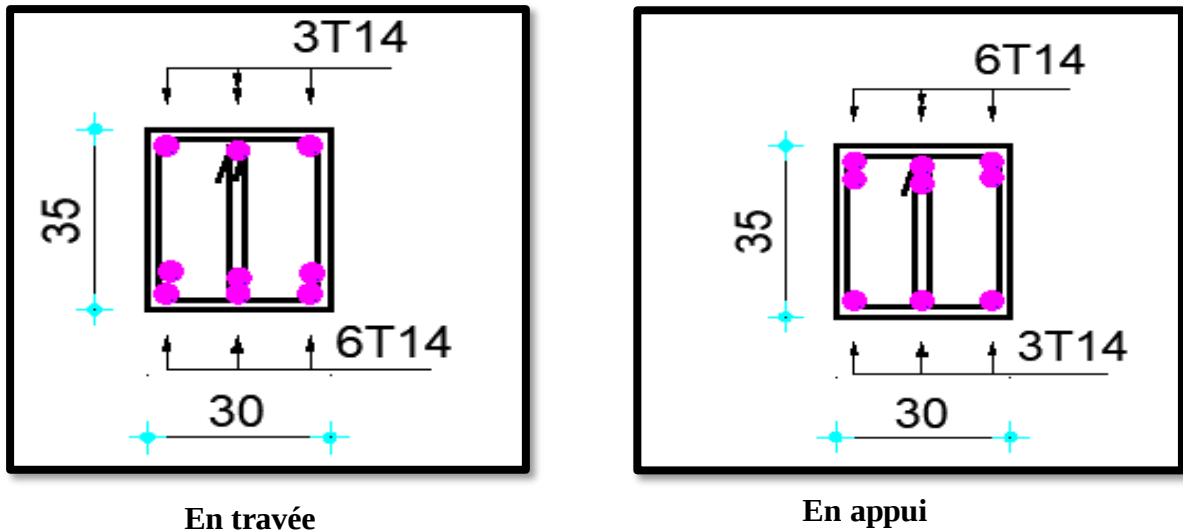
Croquis de ferrailage de la poutre principale.
